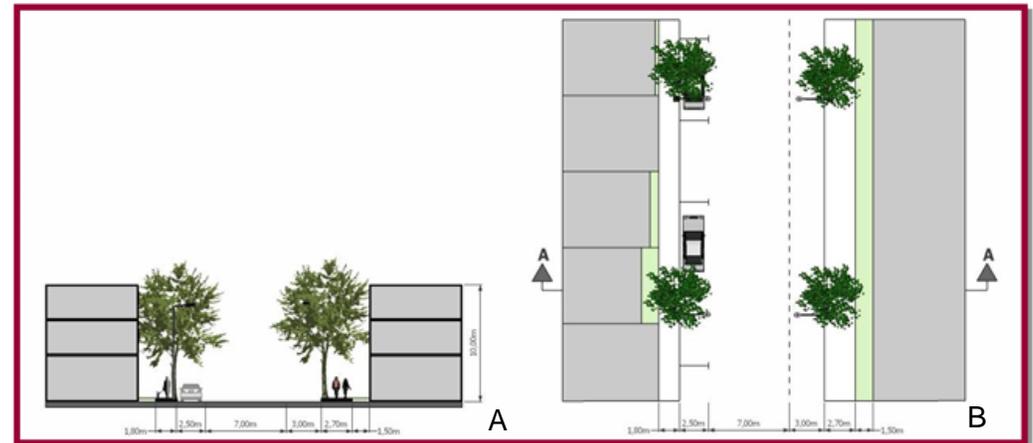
(A) Coupe et (B) plan de la rue Le Ber
